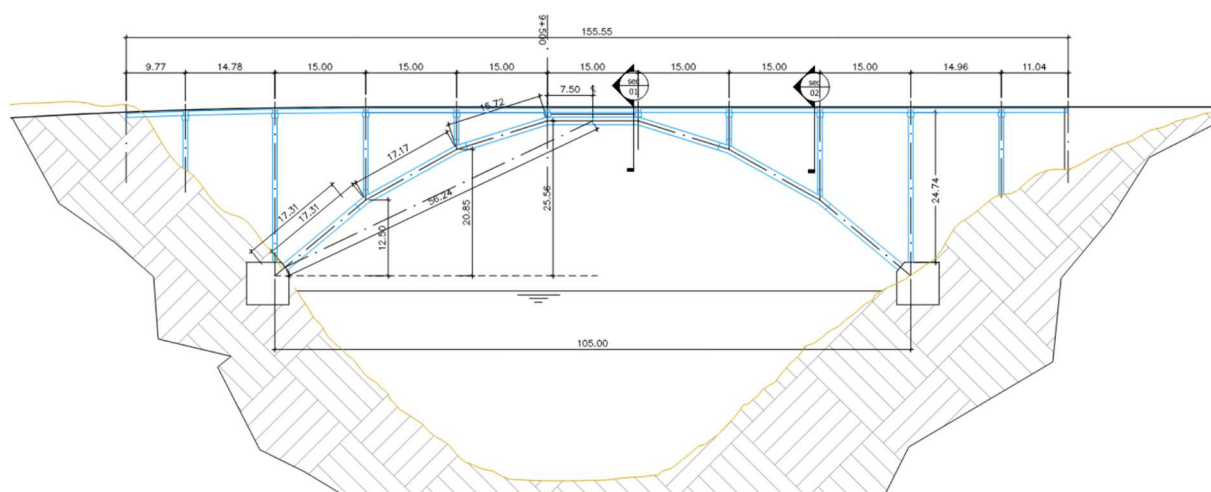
Corte longitudinal del puente sobre el río Sever (imagen esquemática s/escala)
